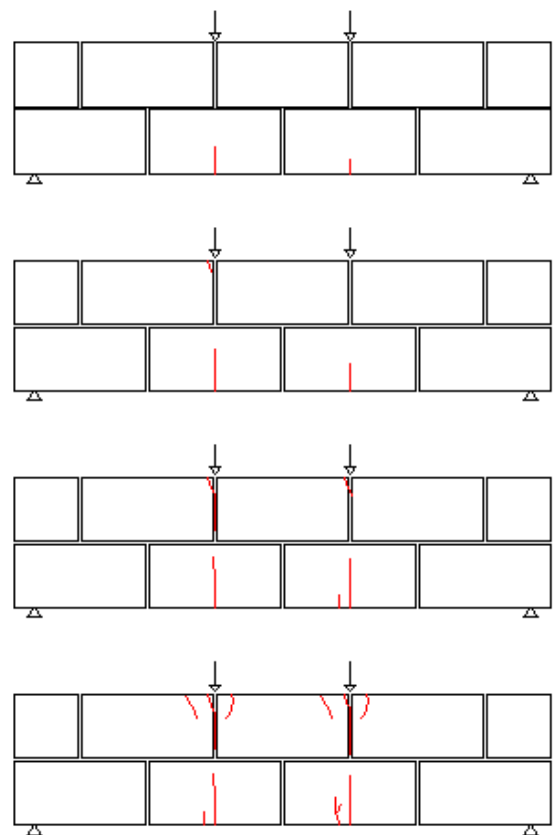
Mapeamento das fissuras VCE+2.
